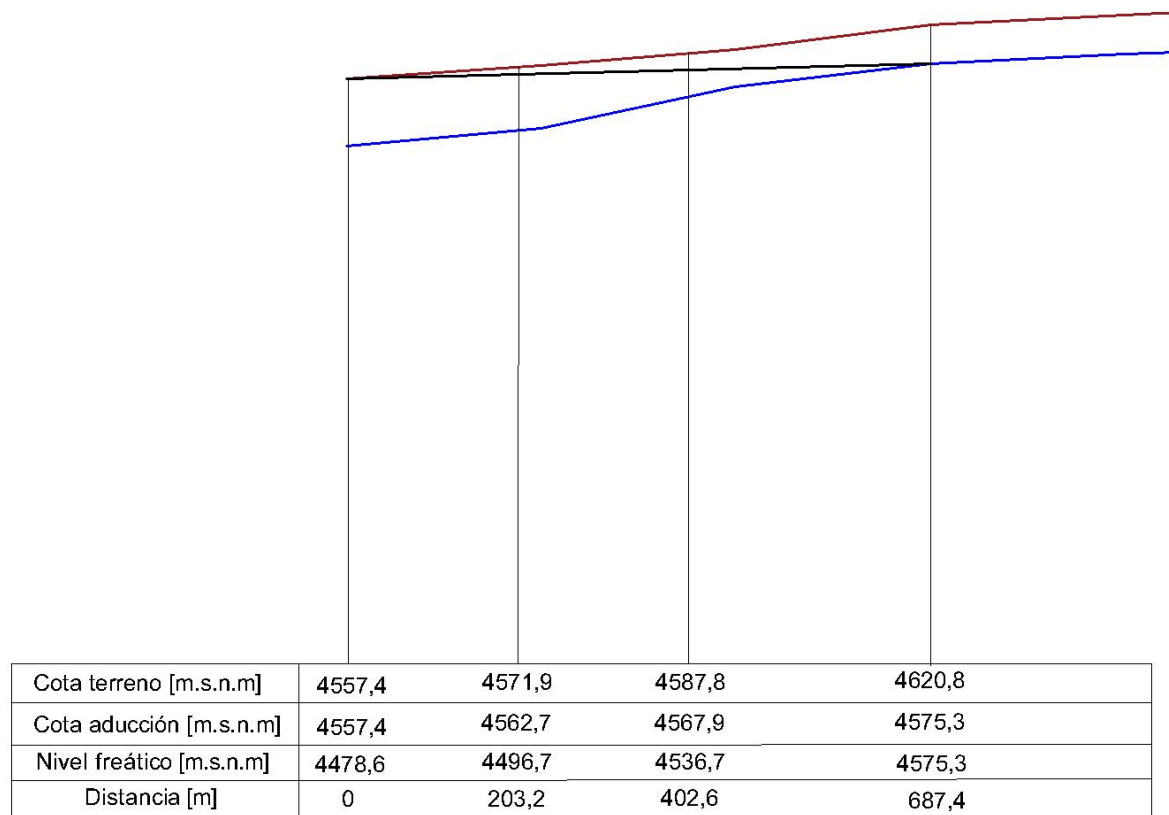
Perfil longitudinal de aducción en Quebrada 14.
